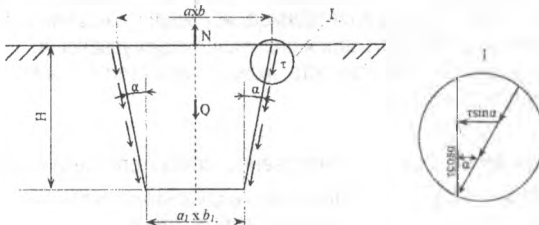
Расчётная схема для определения требуемого усилия извлечения трамбовки из грунта со схемой раскладки сил.
